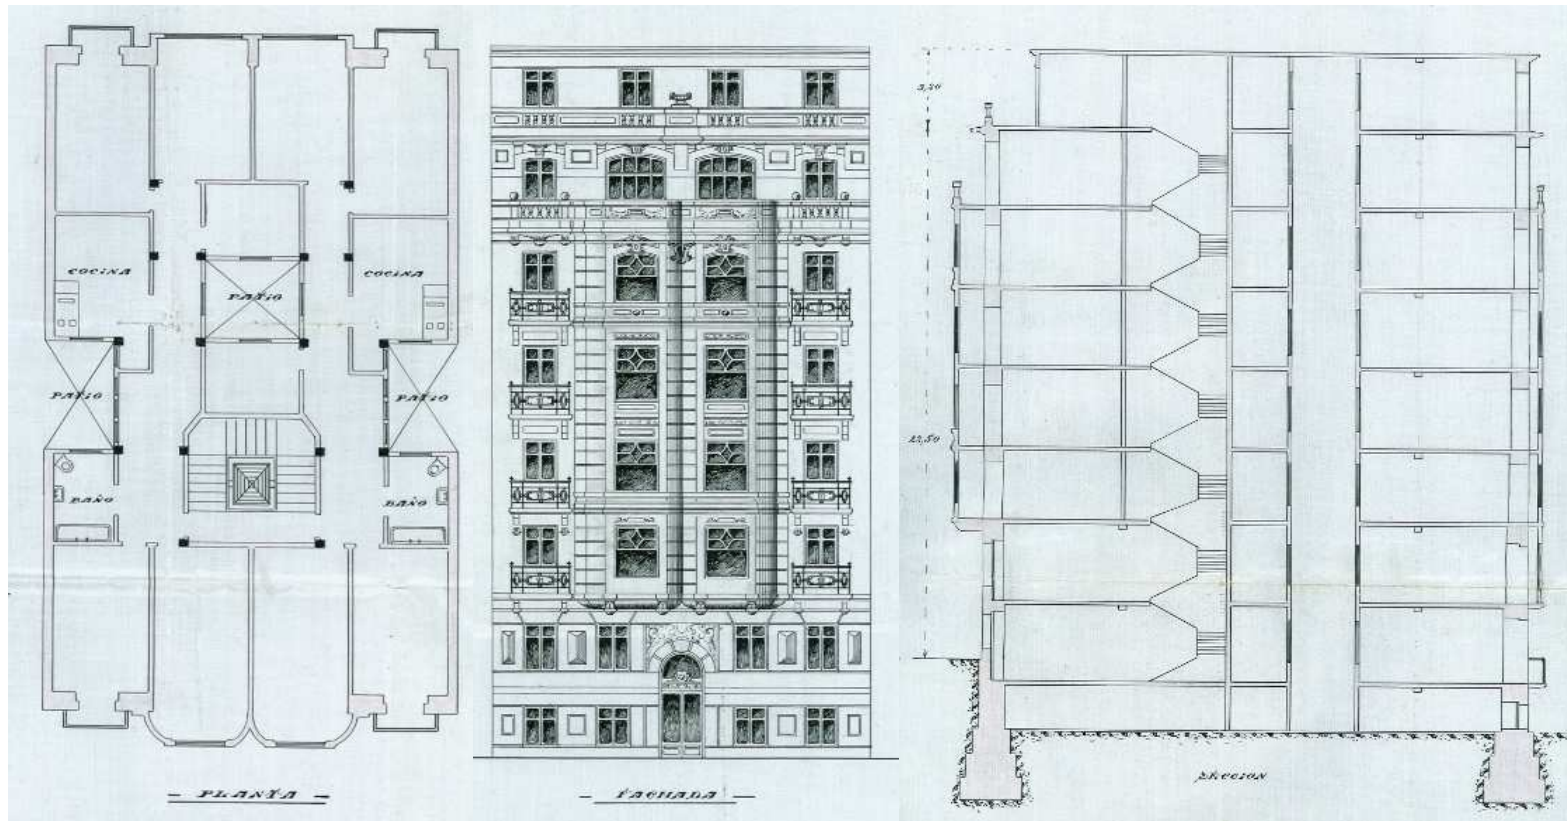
Plano de planta, alzado y sección del inmueble de Estilo Decimonónico sito en el Pº Colón nº 15 del barrio de Gros
